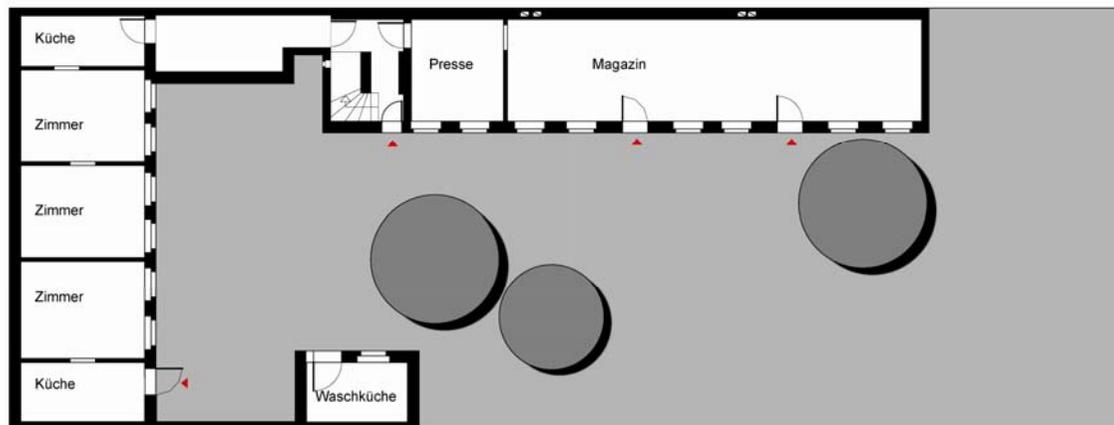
Grundriss Erdgeschoss, 1925
